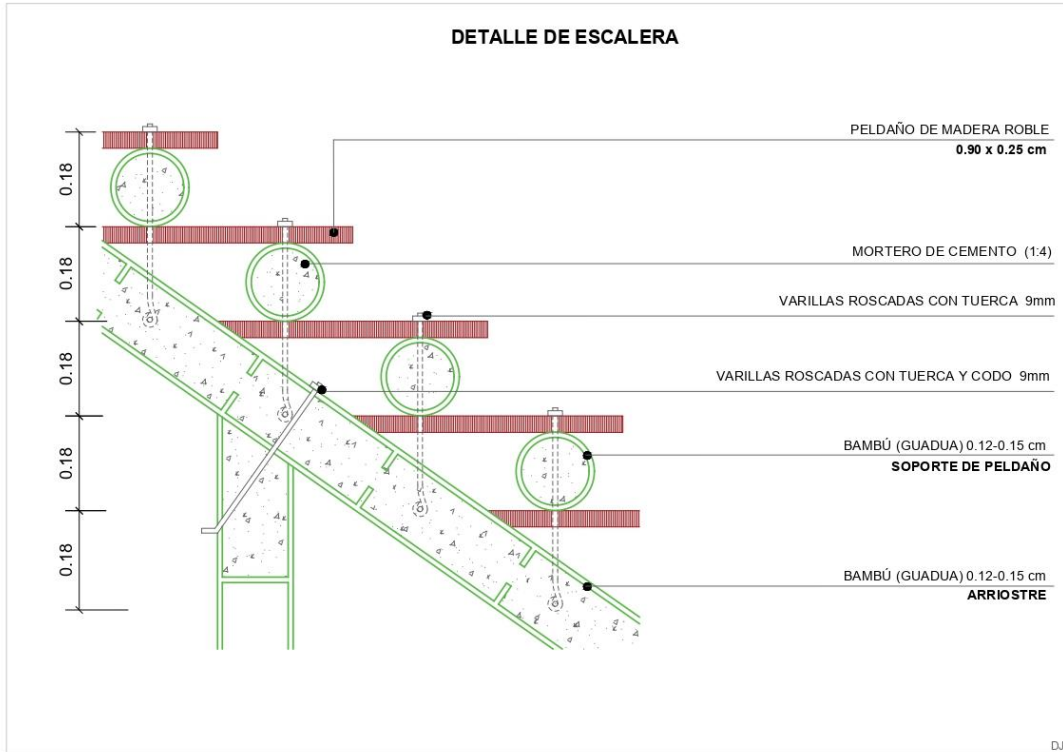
Detalles constructivos de escalera. Fuente: El autor
